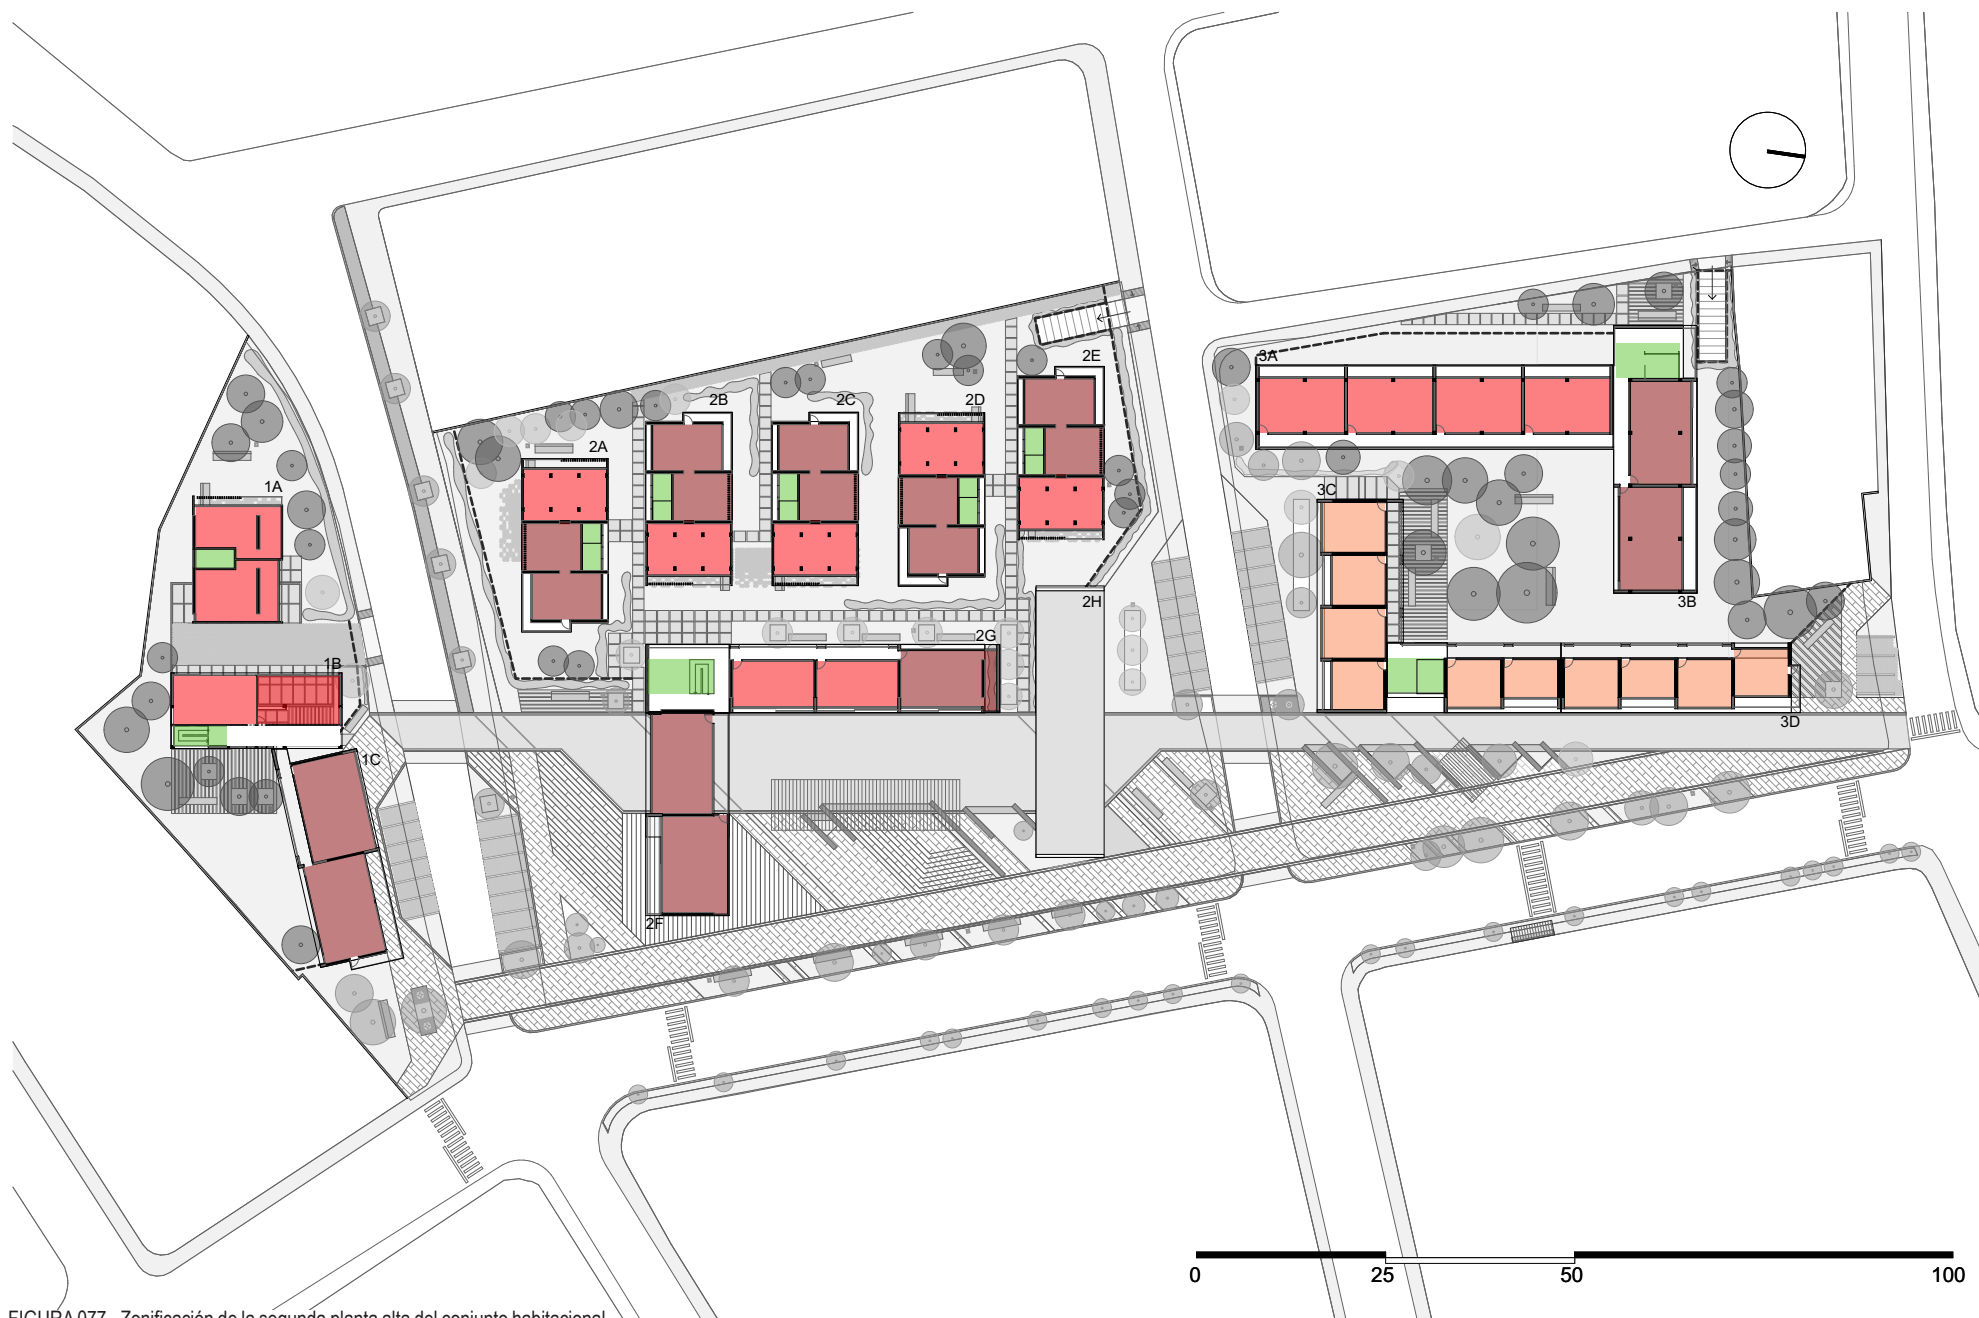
\_ Zonificación de la segunda planta alta del conjunto habitacional
